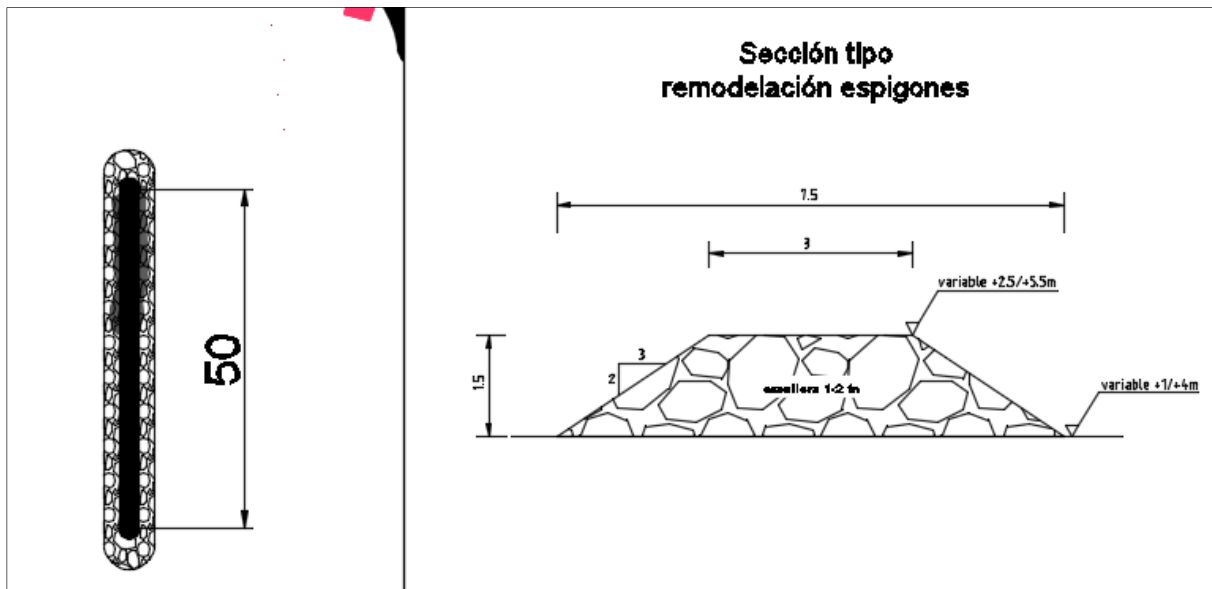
Detalle del recrecimiento de los espigones. Planta y perfil tipo
